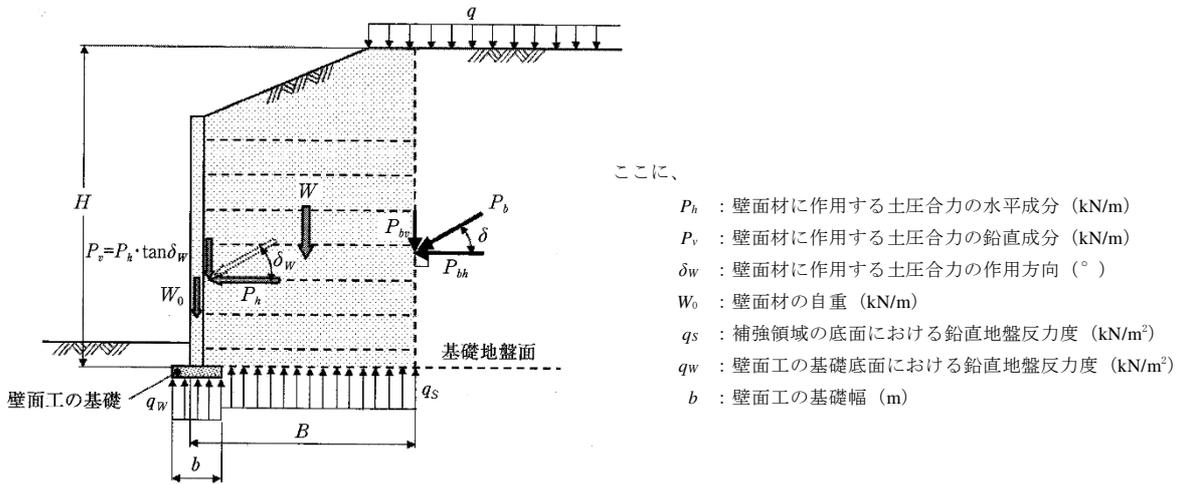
補強土壁の地盤反力度分布の考え方⁸⁾
